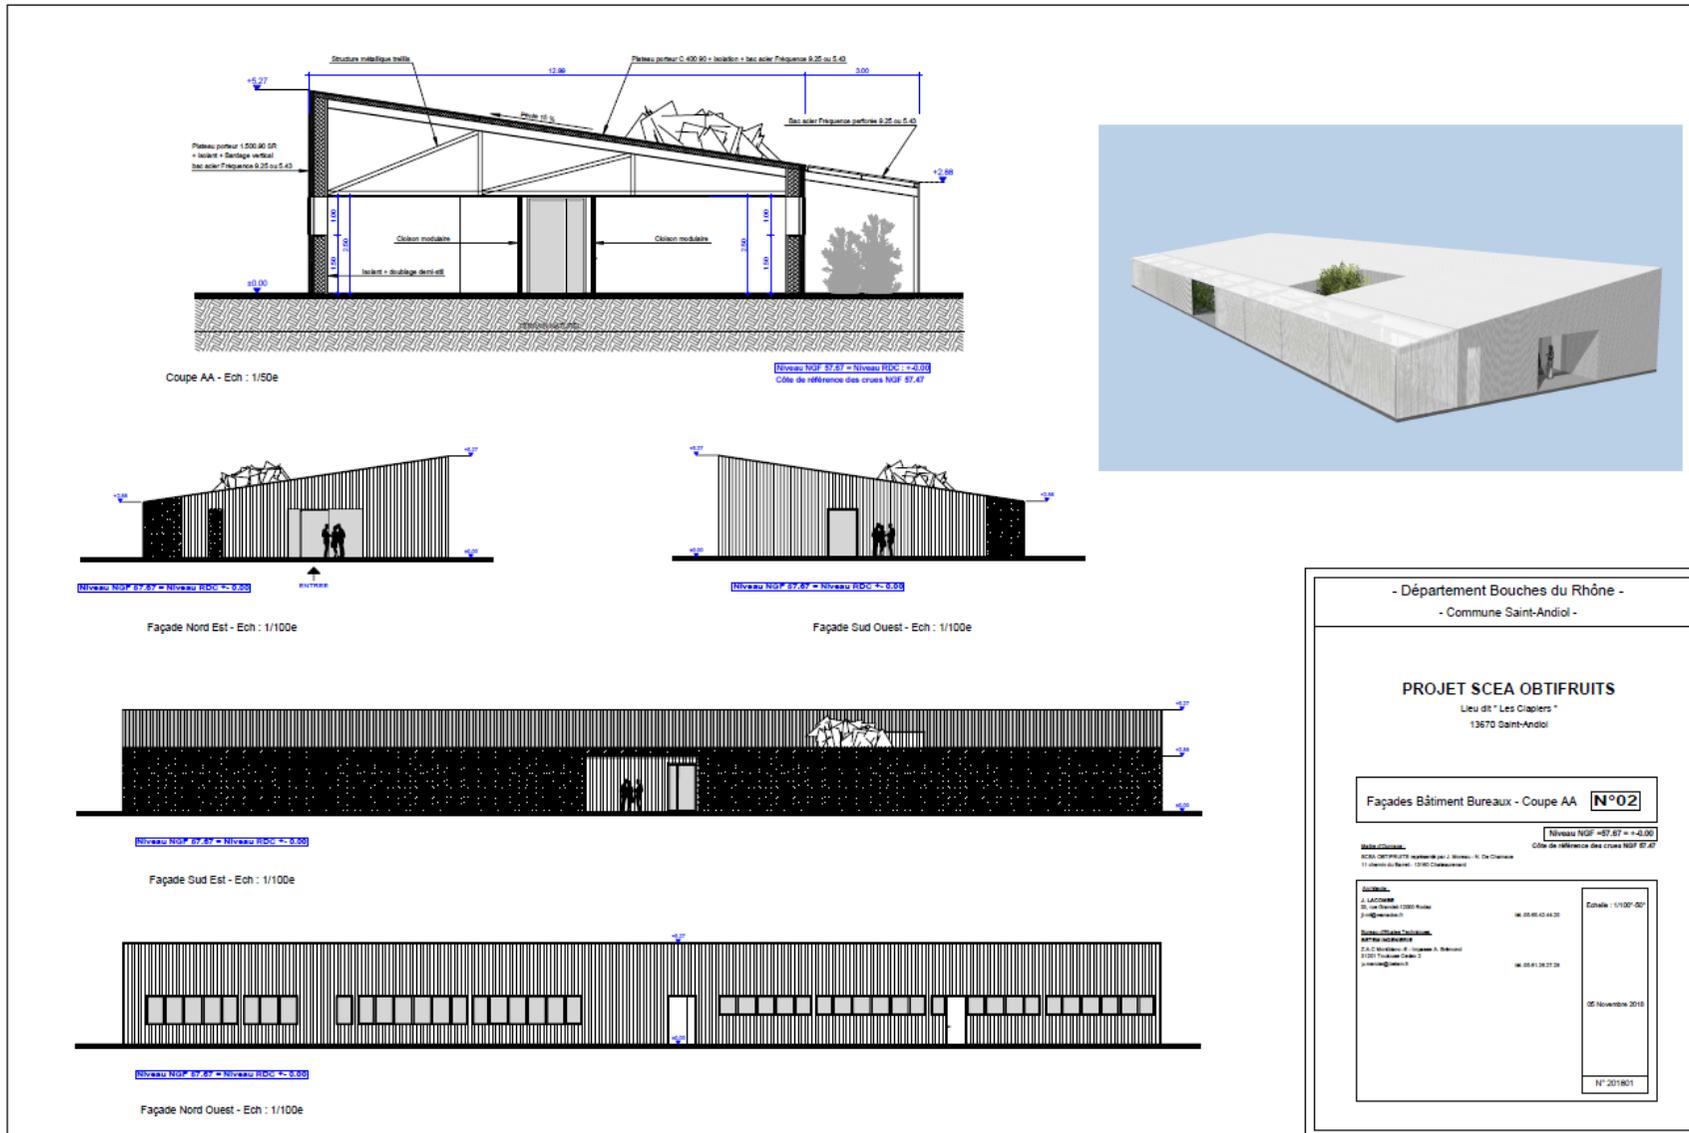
Façade des bureaux – coupe AA (source : SCEA OBTIFRUIT, 05/11/2018)
